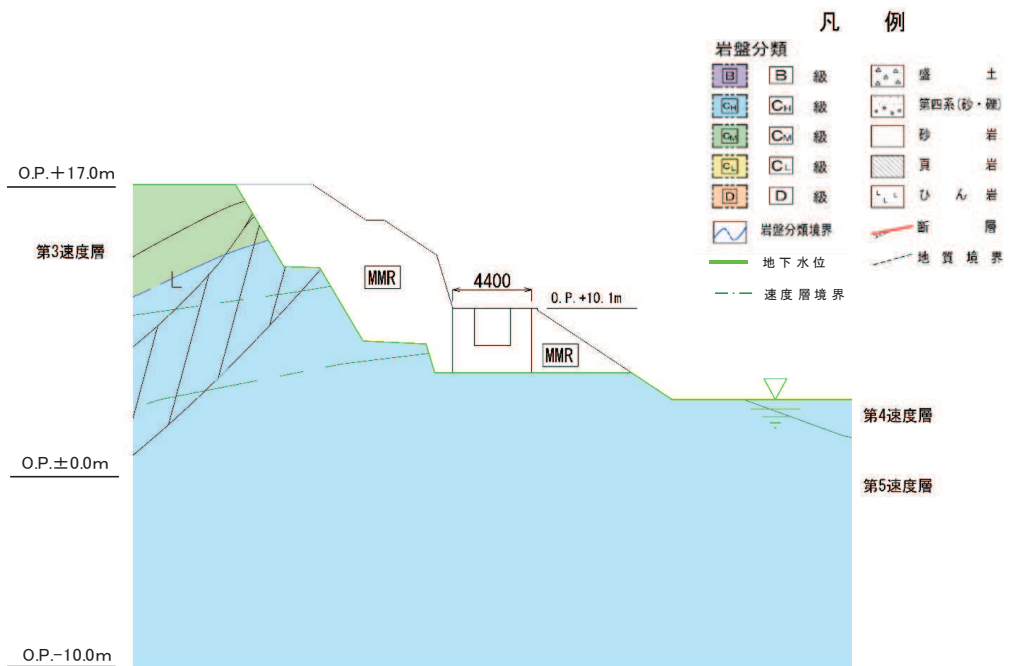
出口側集水ピットの荷重算出断面図 (A-A 断面) (特記なき寸法は mm を示す)
